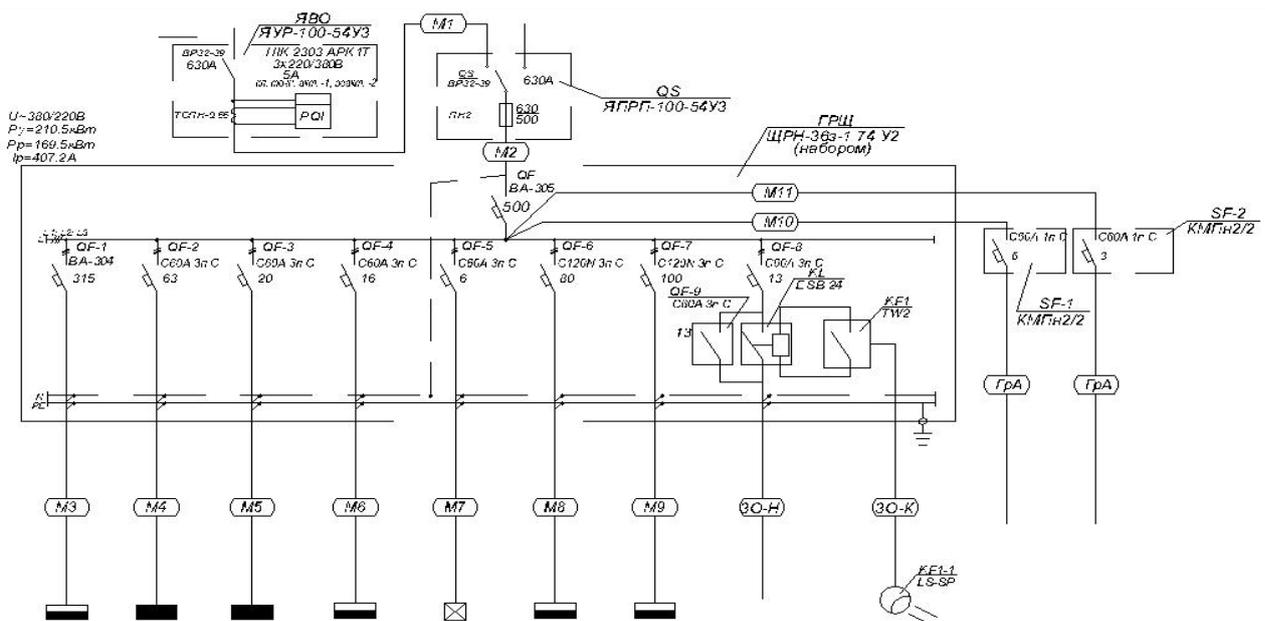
Схема электроснабжения ОС п. Дубна
